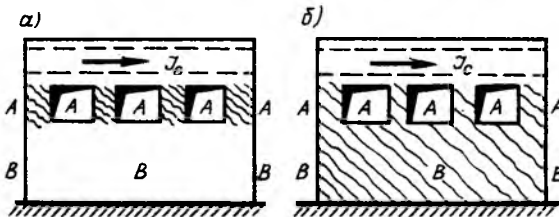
Расчетная схема фрагмента здания с проемами под действием силы а — ожидаемая схема разрушения; б — то же фактическая
